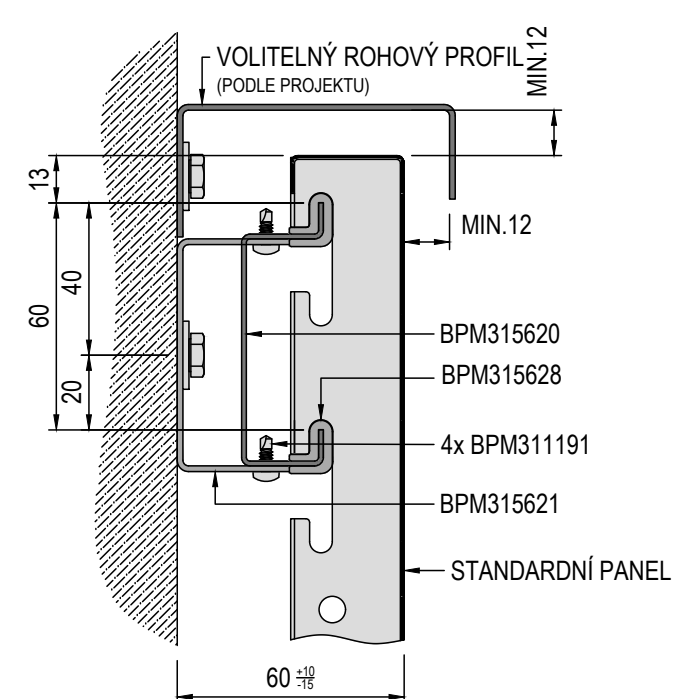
STANDARDNÍ VIDITELNÉ UKONČENÍ
